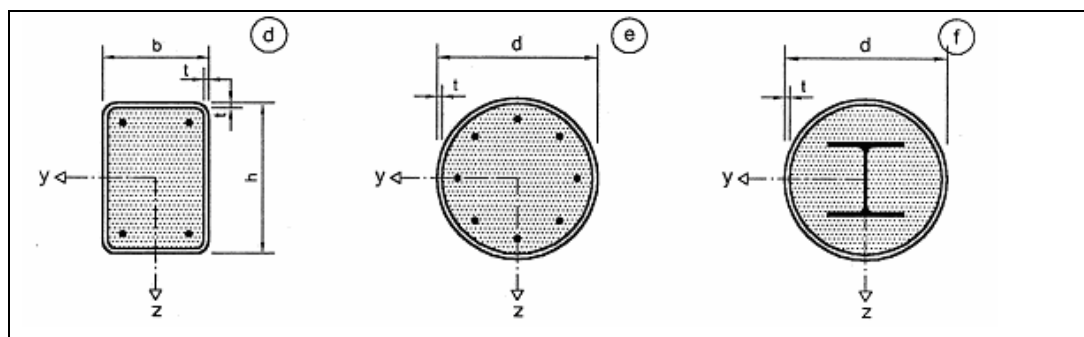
(d) e (e) Seções transversais de pilares mistos tubulares preenchidos, com ou sem armaduras internas e (f) com perfil metálico interno. (Ref. Eurocode 4).
